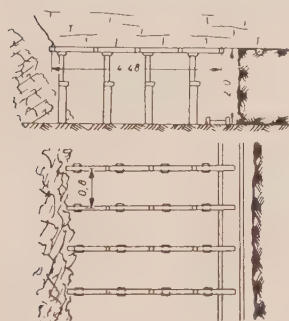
Ausbauschema beim Strebruchbau mit Panzerförderer
